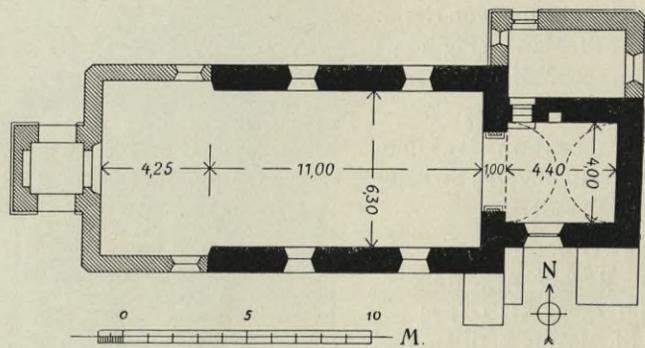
Mettenbach. Pfarrkirche. Grundriß.
